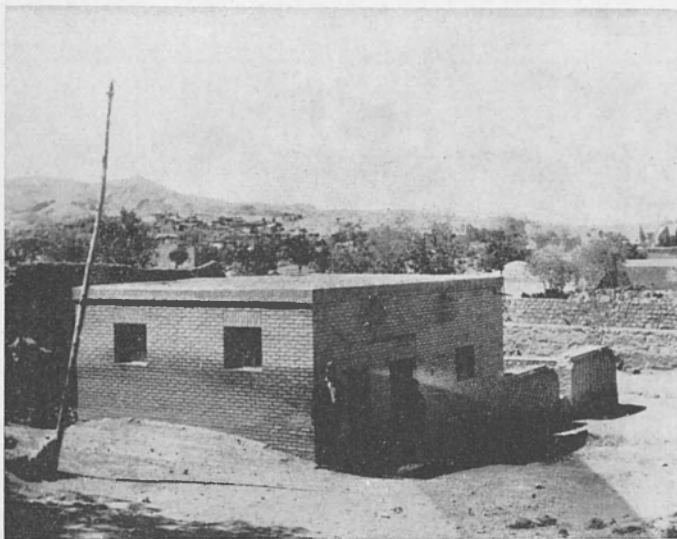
Maison construite en brique et poutre armée de Kakhk.
